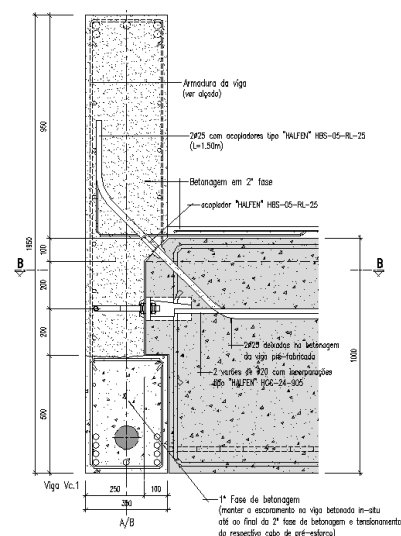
Pormenorização do apoio das vigas pré-fabricadas em betão armado pré-esforçado, com dispositivos tipo Halfen.
